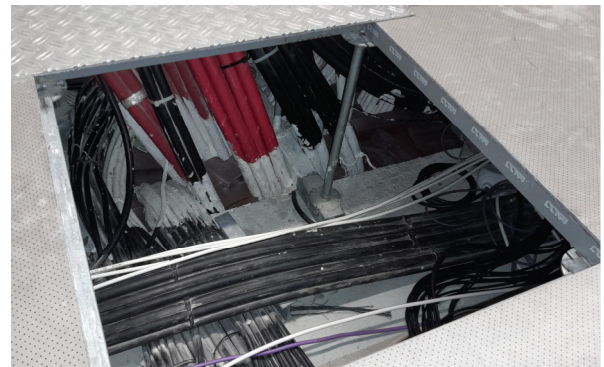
Brandschott: Betriebsgebäude 1. OG nach EG
